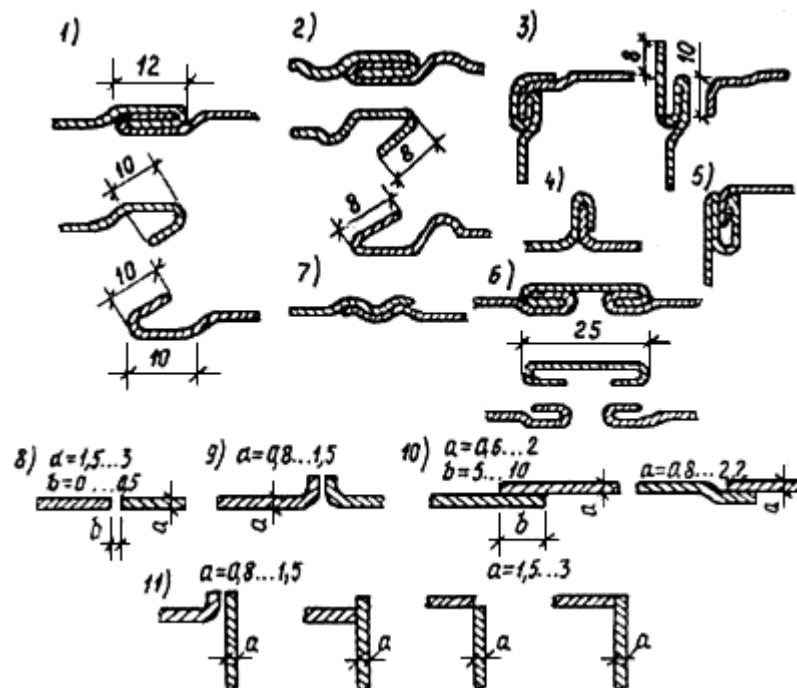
Виды фальцевых и сварных соединений металлических воздуховодов:
